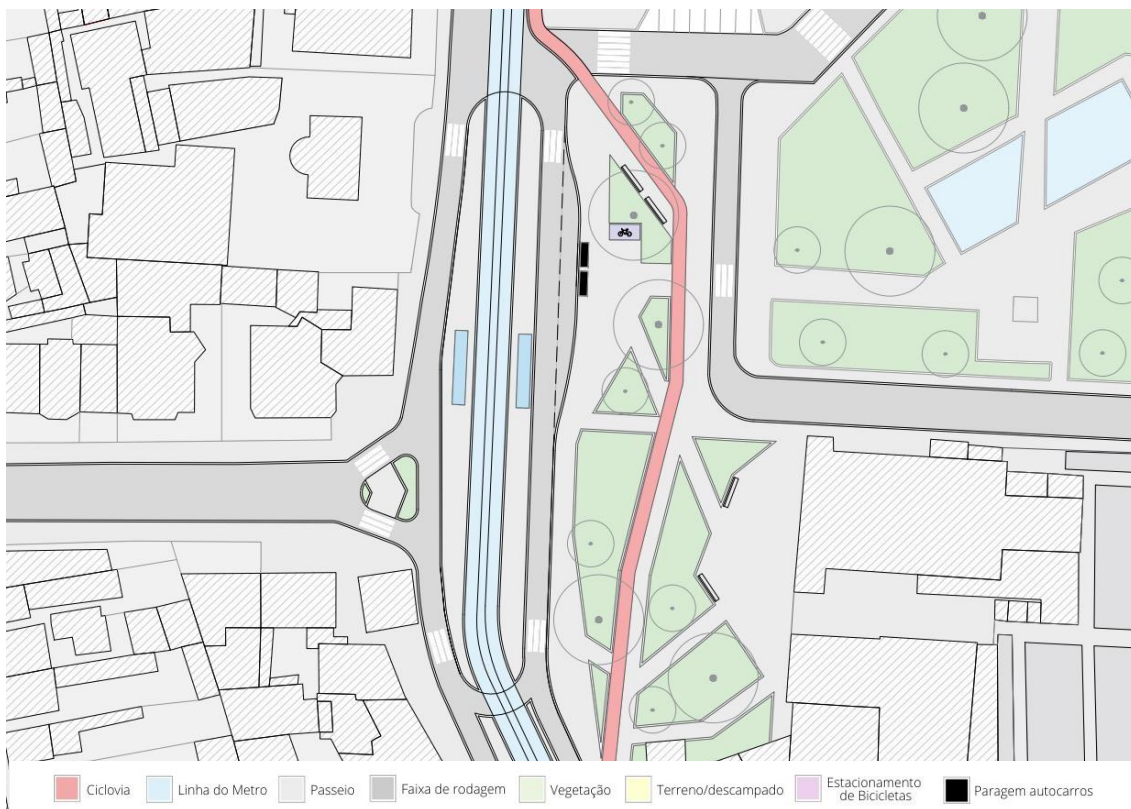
Planta 05 – Avenida Doutor Fernando Aroso
